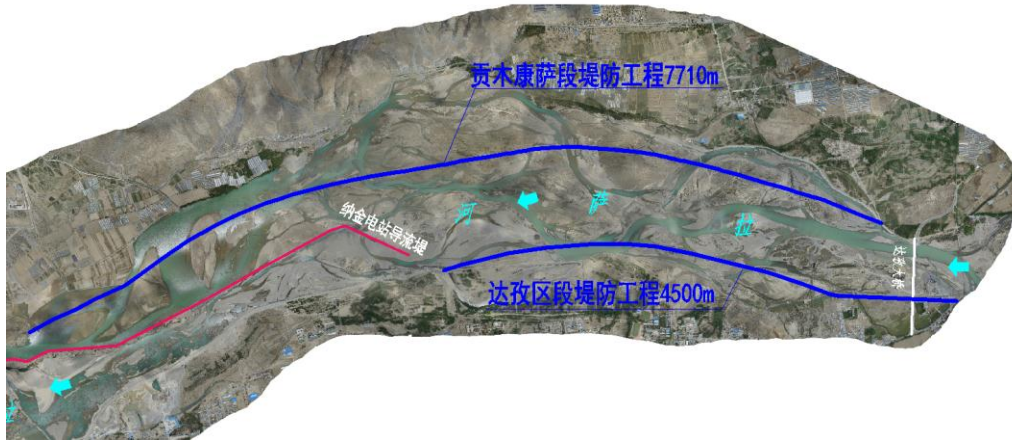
贡木康萨段与达孜区段堤防工程平面布置示意图
